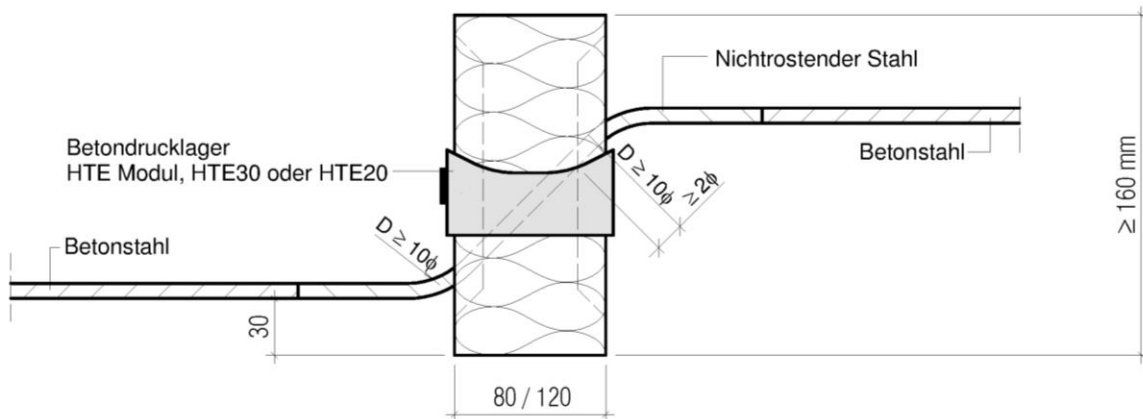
Schöck Isokorb® Typ Q mit Betondrucklager
